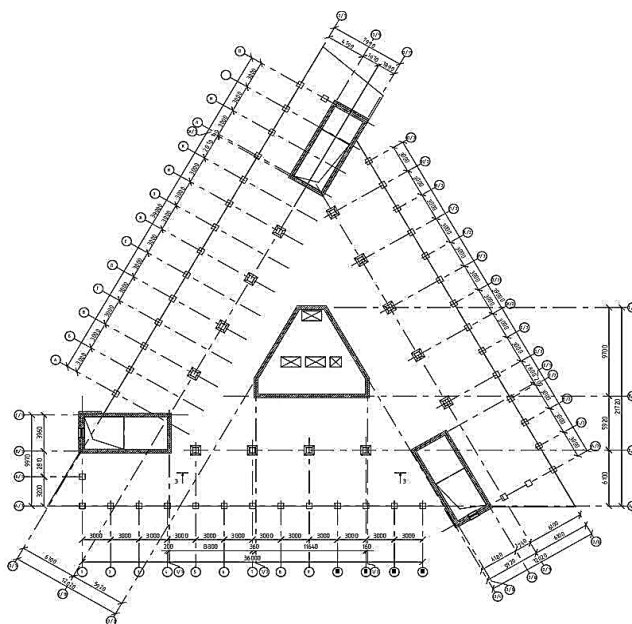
Безбалкове монолітне перекриття з опиранням на капітелі - 3д
